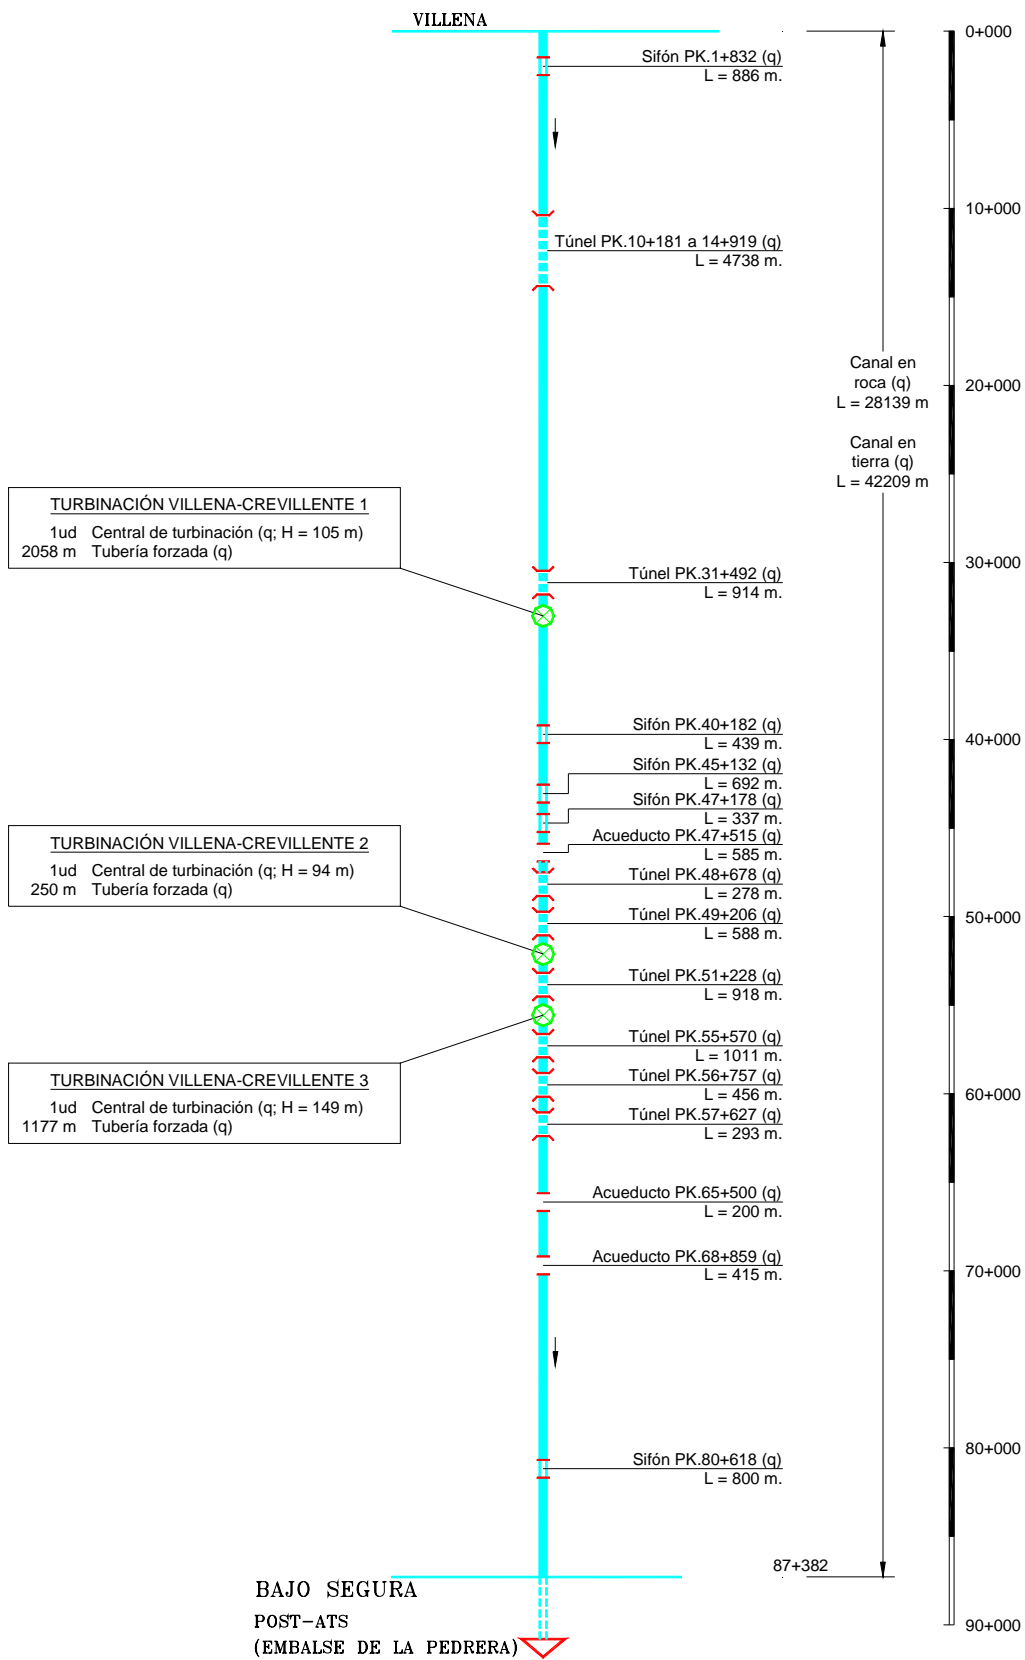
Conducción Villena - Bajo Segura. Esquema en planta
